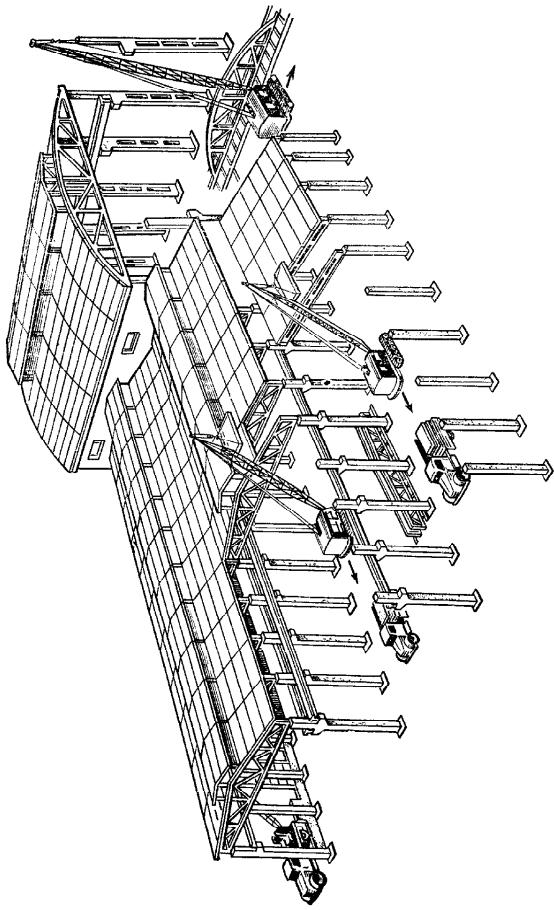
Схема монтажа одноэтажного промышленного здания (подмосты условно не показаны)
